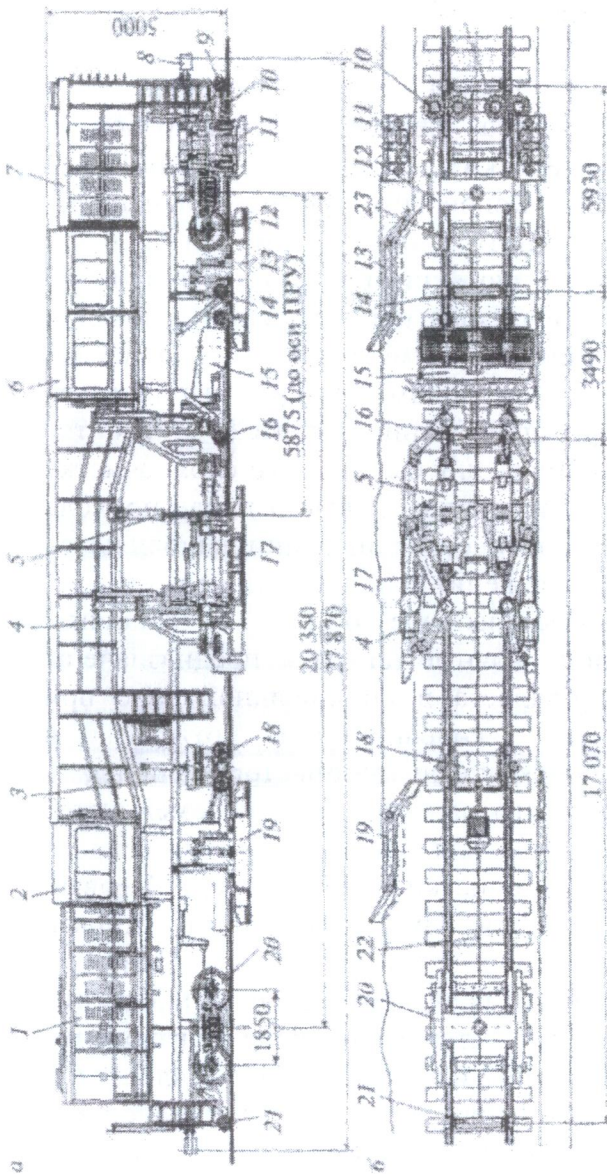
Выправочно-подбивочная машина ВПО-3-3000С: 1 — основной и дополнительный дизель-электрические агрегаты переменного тока; 2 и 6 — передняя и задняя кабины управления; 3 — ферма; 4 — механизм перемещения (подвески) виброплит; 5 — ПРУ; 7 — насосная станция; 8 — автосцепка; 9, 14, 16 и 21 — задняя, промежуточные и передняя тележки КИС; 10 — активная рельсовая щетка; 11 — уплотнитель откосно-плечевой и междупутной зон балластной призмы; 12 и 20 — задняя и передняя ходовые тележки (типа 18-100); 13 — планировщик; 15 — подборщик балласта; 17 — основная виброплита; 18 — рабочий орган динамической стабилизации пути; 19 — дозатор; 22 и 23 — тросы-хорды рабочей и контрольной КИС
